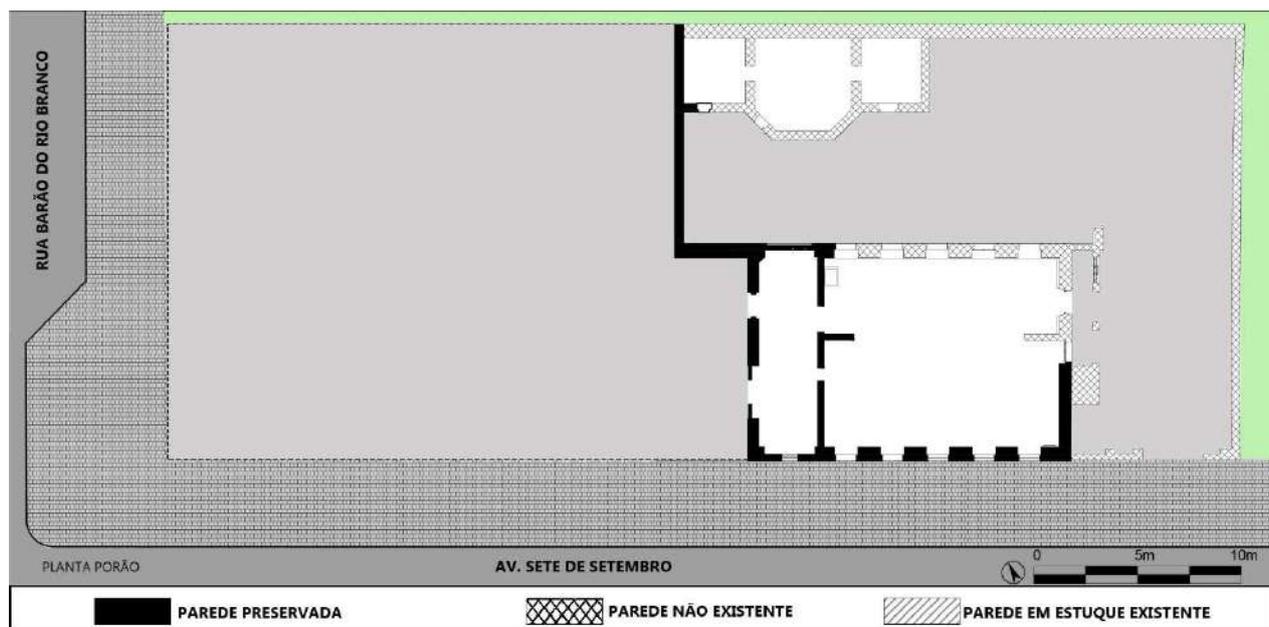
Planta baixa situação atual ao porão. Fonte: a autora.
